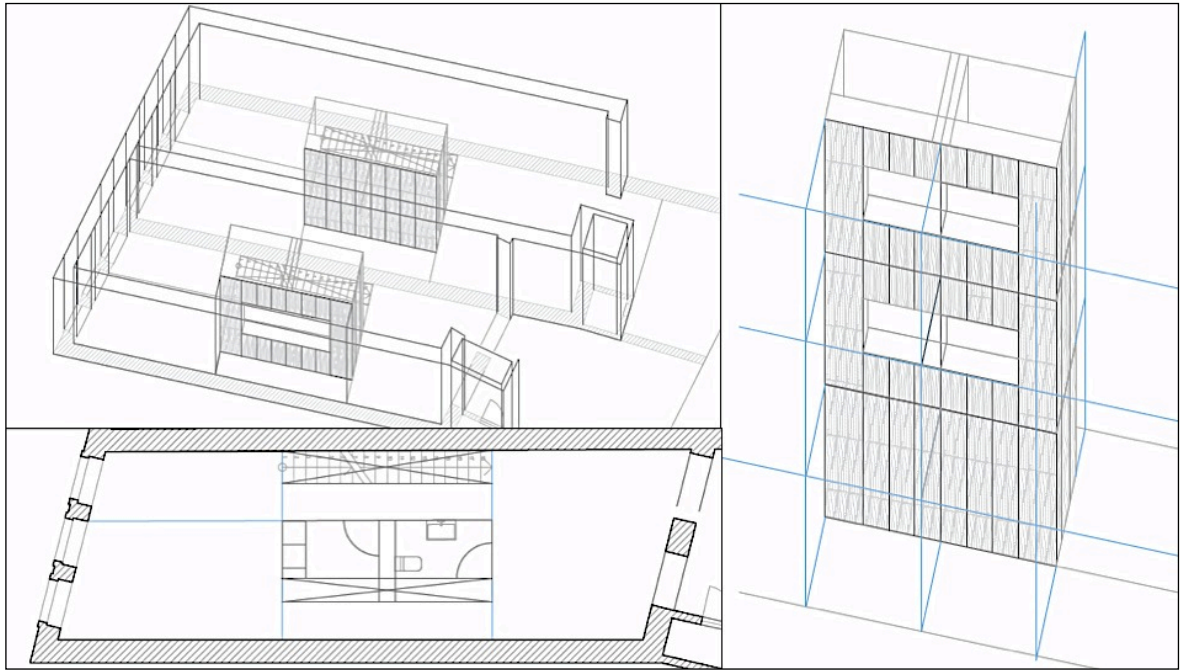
Habitação Rua da Bandeirinha, Plantas, fotografia e pormenor módulo central
